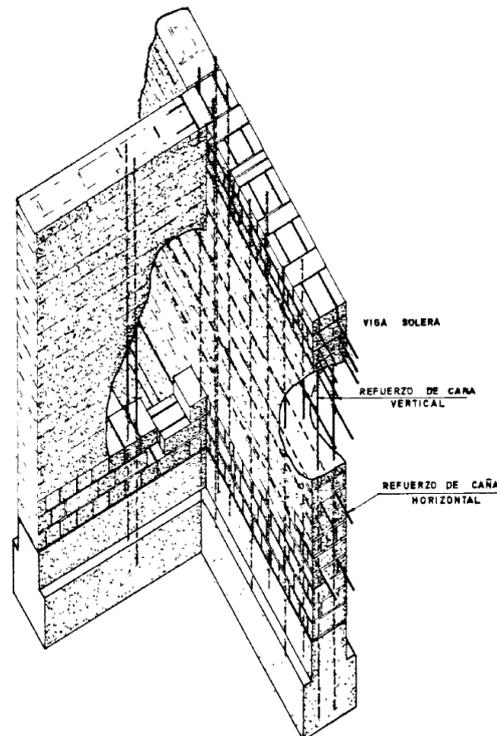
Detalle de intersección de muros. Ver viga solera, refuerzo de caña vertical y horizontal en muros.
